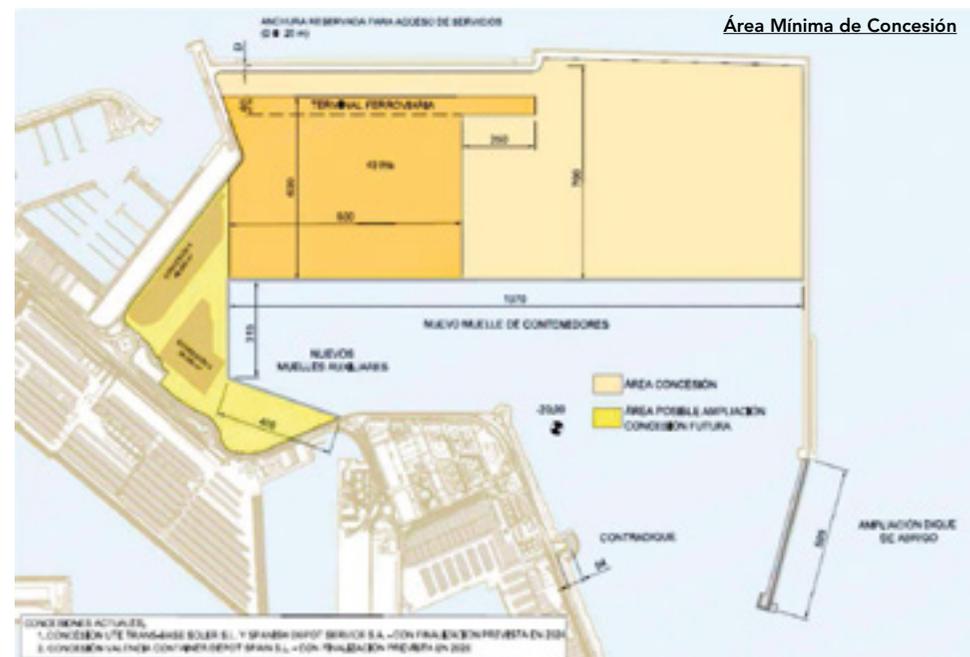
Planta de la nueva terminal en la ampliación norte
